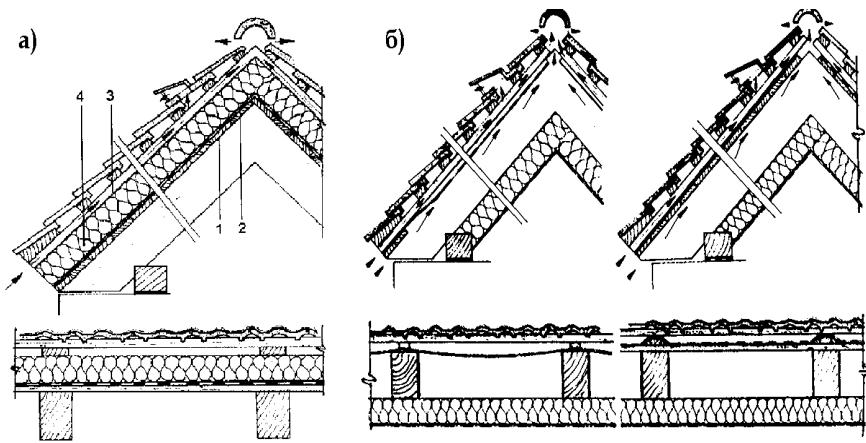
Теплоизоляция мансарды над и под стропилами.
